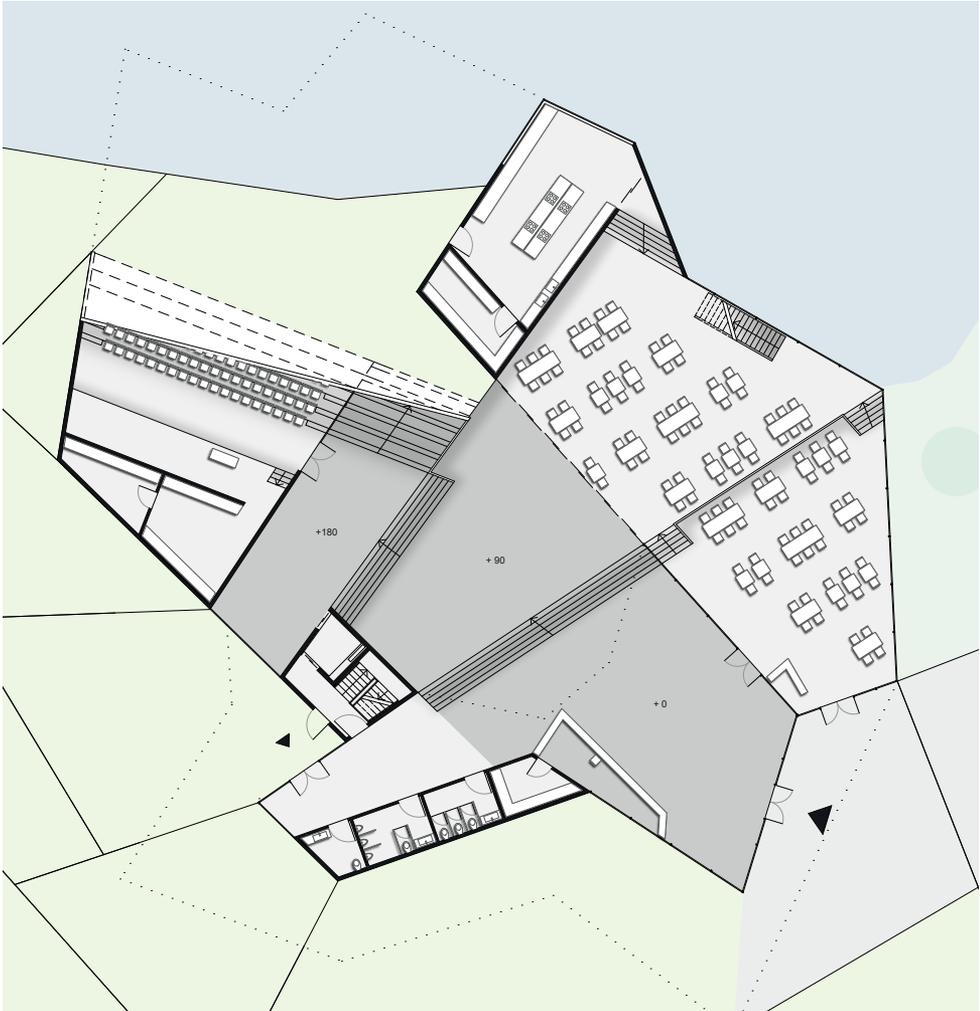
Grundriss +0 bis +180 cm
